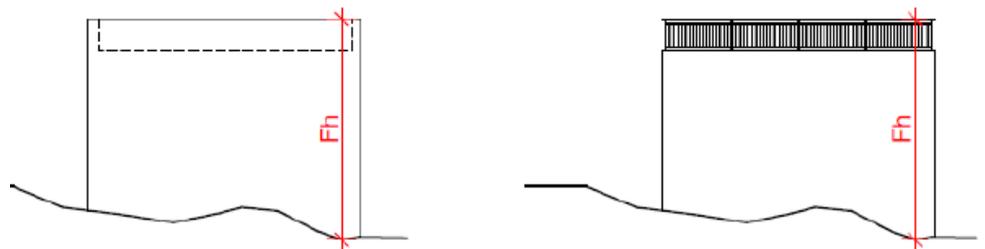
Schema Messweise Fassadenhöhe bei Flachdachbauten
